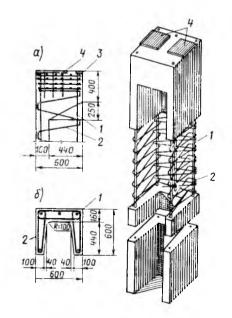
Схема колонны высотой 9,6 м a — конструкция оголовка;  $\delta$  — поперечное сечение; I — продольная преднапряженная арматура; 2 — поперечная арматура в виде спирали; 3 — арматурные сетки; 4 — закладное изделие
